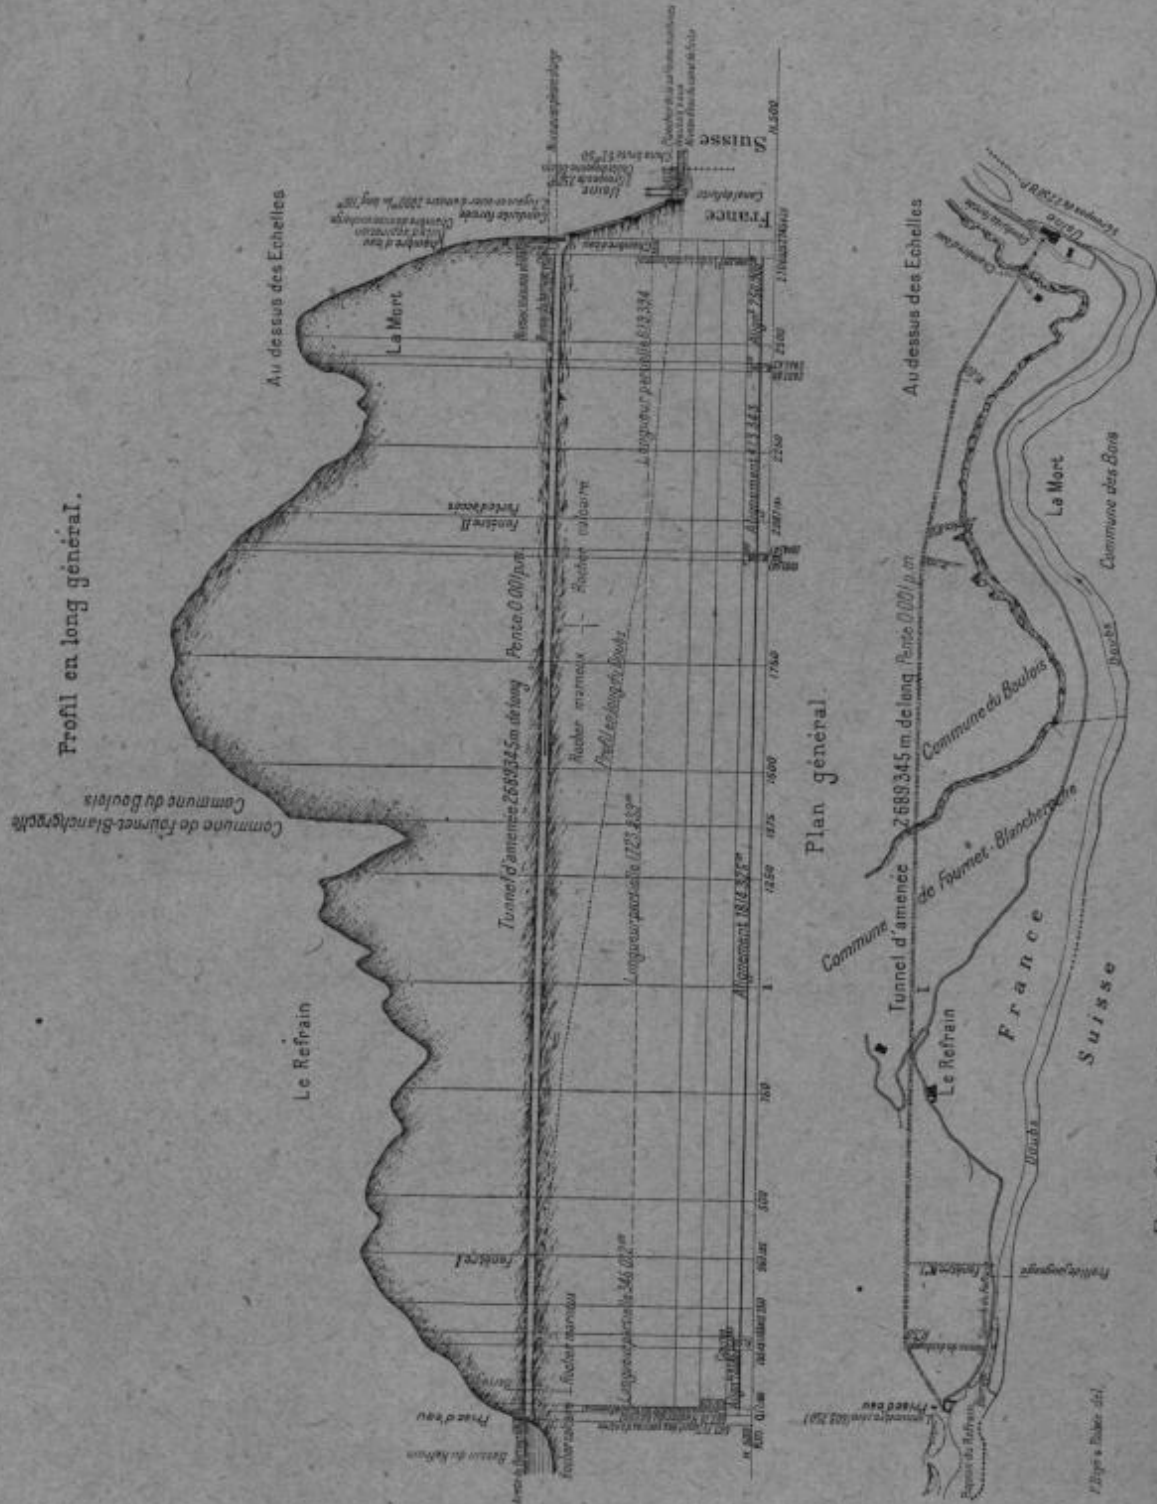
Usine du Refrain. Plan et profil général du canal-tunnel d'aménage.
